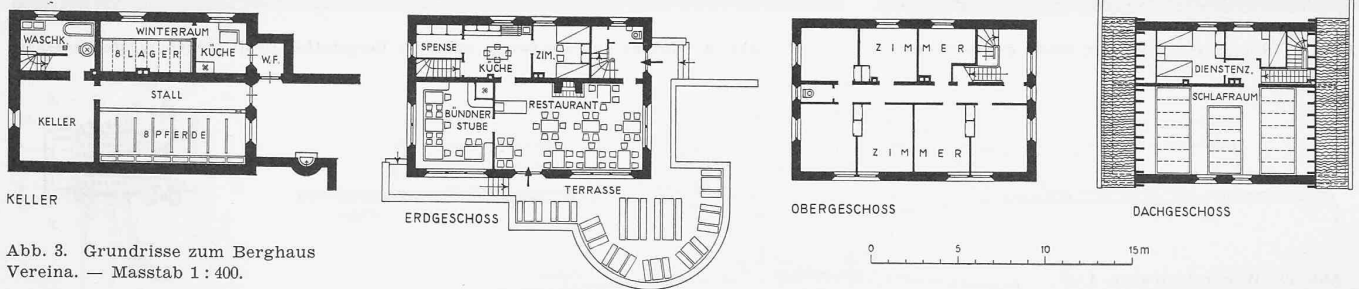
Grundrisse zum Berghaus Vereina. — Masstab 1 : 400.
